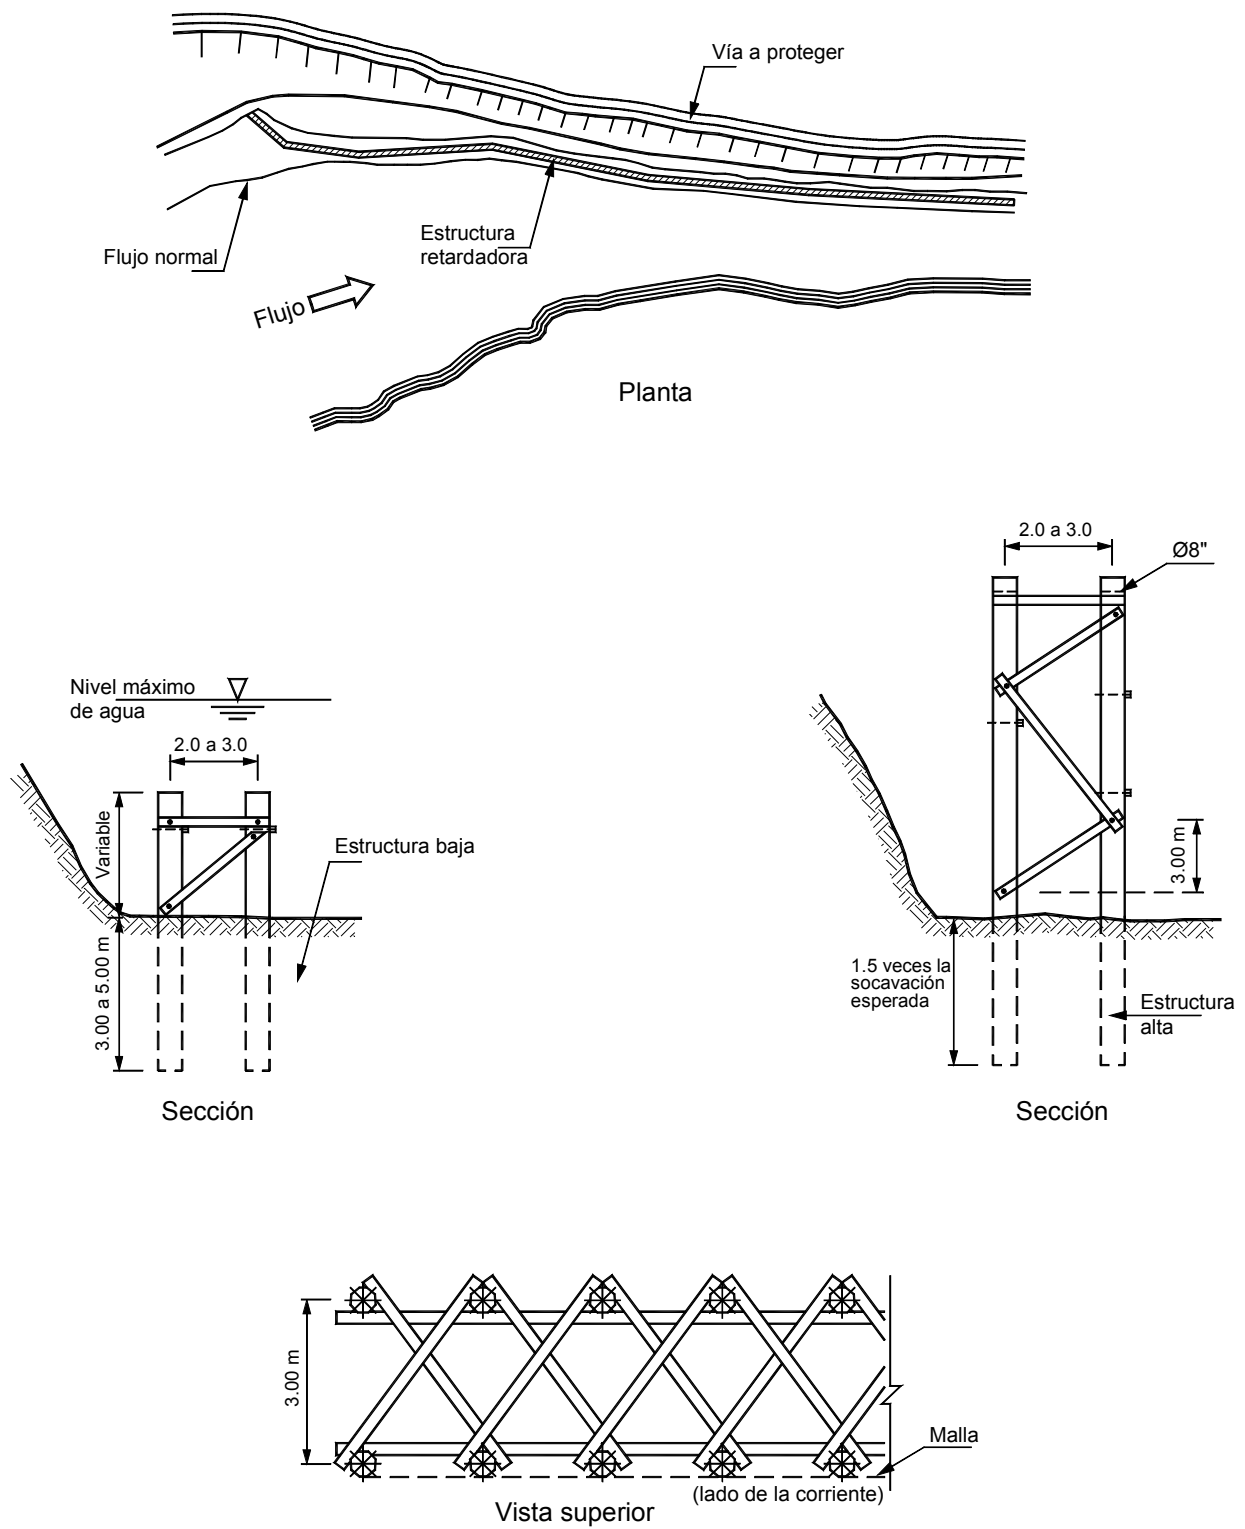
Estructura retardadora con pilotes de madera.
